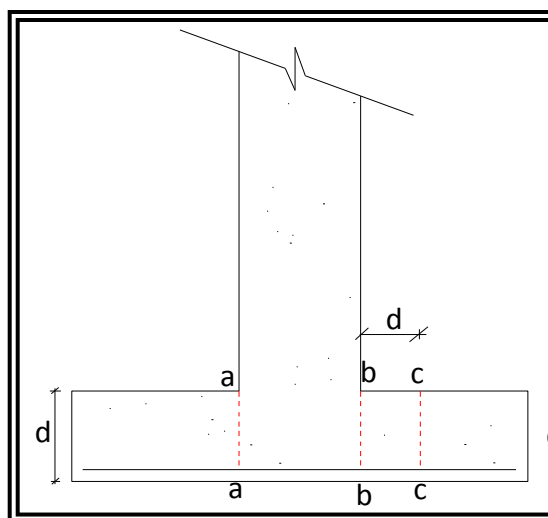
Secciones críticas para cortante y momento en cimentaciones de concreto reforzado (a-a, b-b Secciones críticas para momento; c-c y d-d secciones críticas para cortante).
